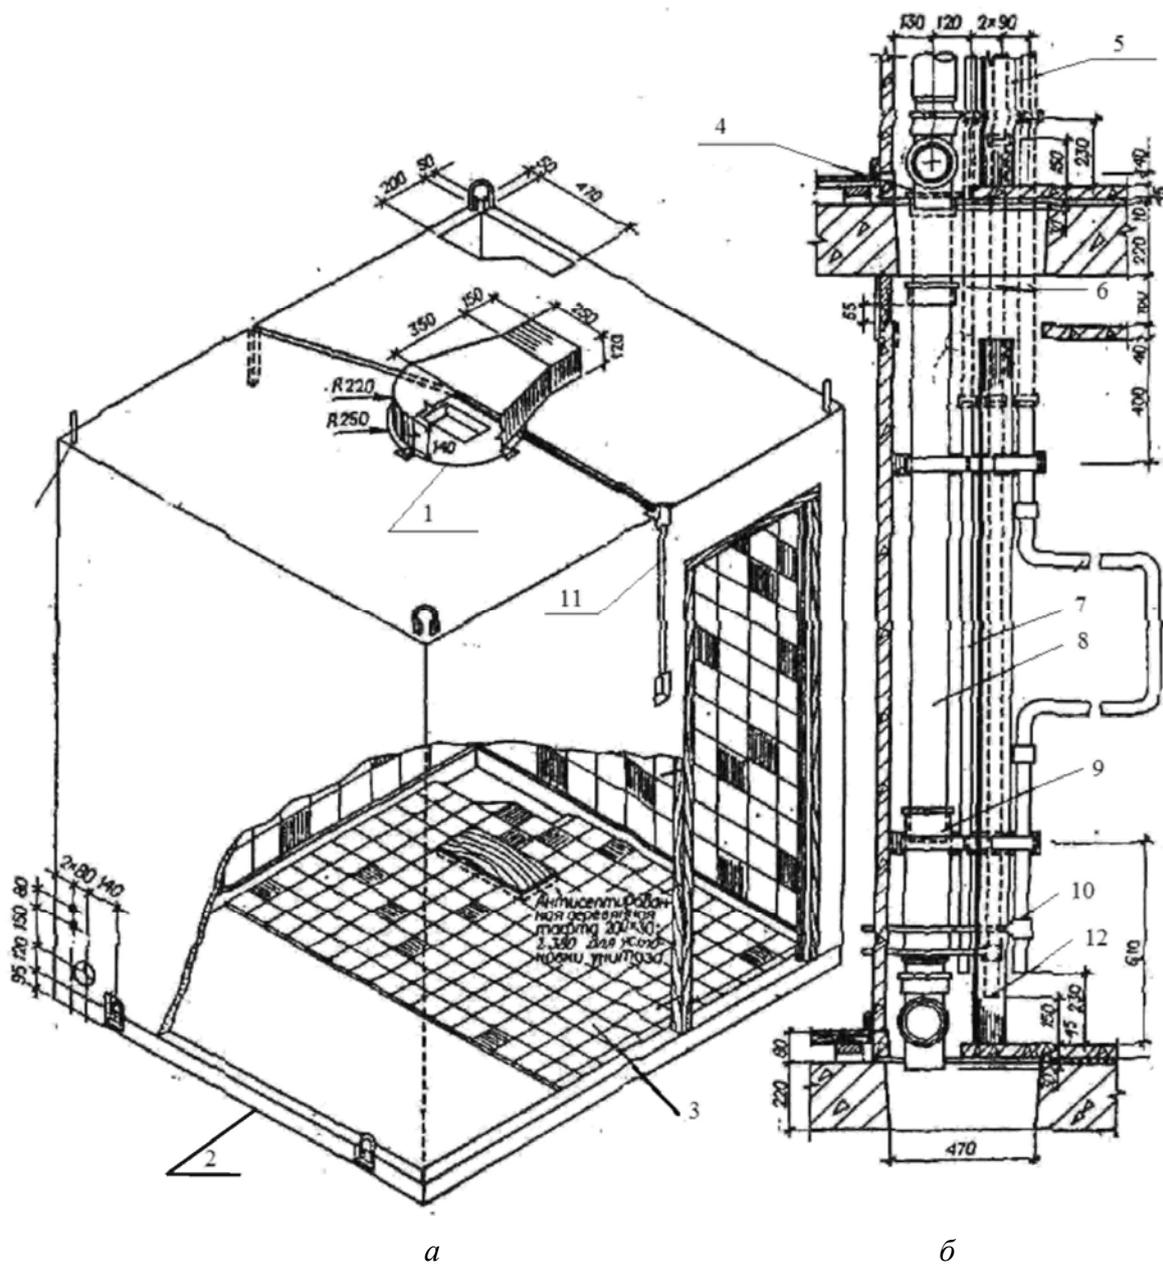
Совмещенная санитарно-техническая кабина типа «колпак»: *а* — общий вид кабины; *б* — схема монтажа стояков: 1 — вентиляционный поворотный патрубок из оцинкованной кровельной стали; 2 — ж/б поддон, приваренный к колпаку в 4 точках; 3 — пол из уложенных в форму керамических плиток; 4 — выдвижение стояка из компенсационного патрубка; 5 — ограждение из инсупака; 6 — монтажные вставки; 7 — циркуляционный стояк; 8 — канализационный стояк; 9 — компенсационный патрубок; 10 — стояк полотенцесушителя; 11 — штрабы для электропроводки; 12 — стояк холодной воды
